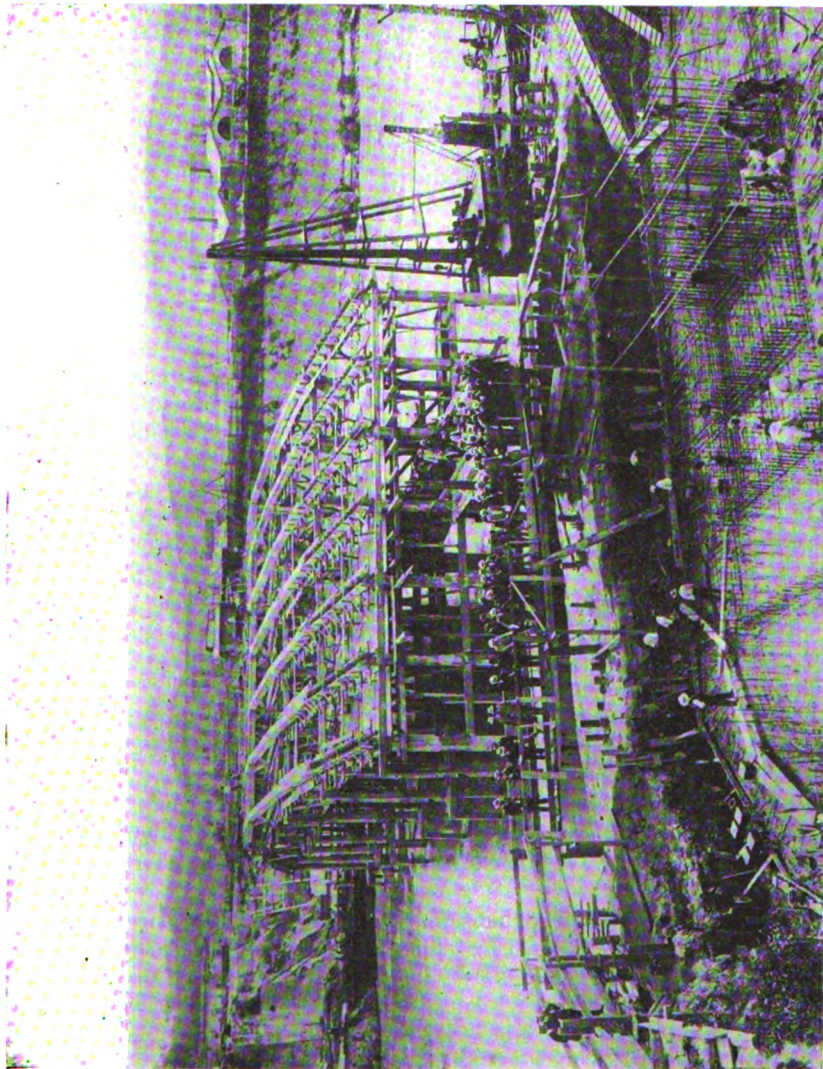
Completamento dell'armatura provvisoria, ed inizio della elevazione spalla destra.
